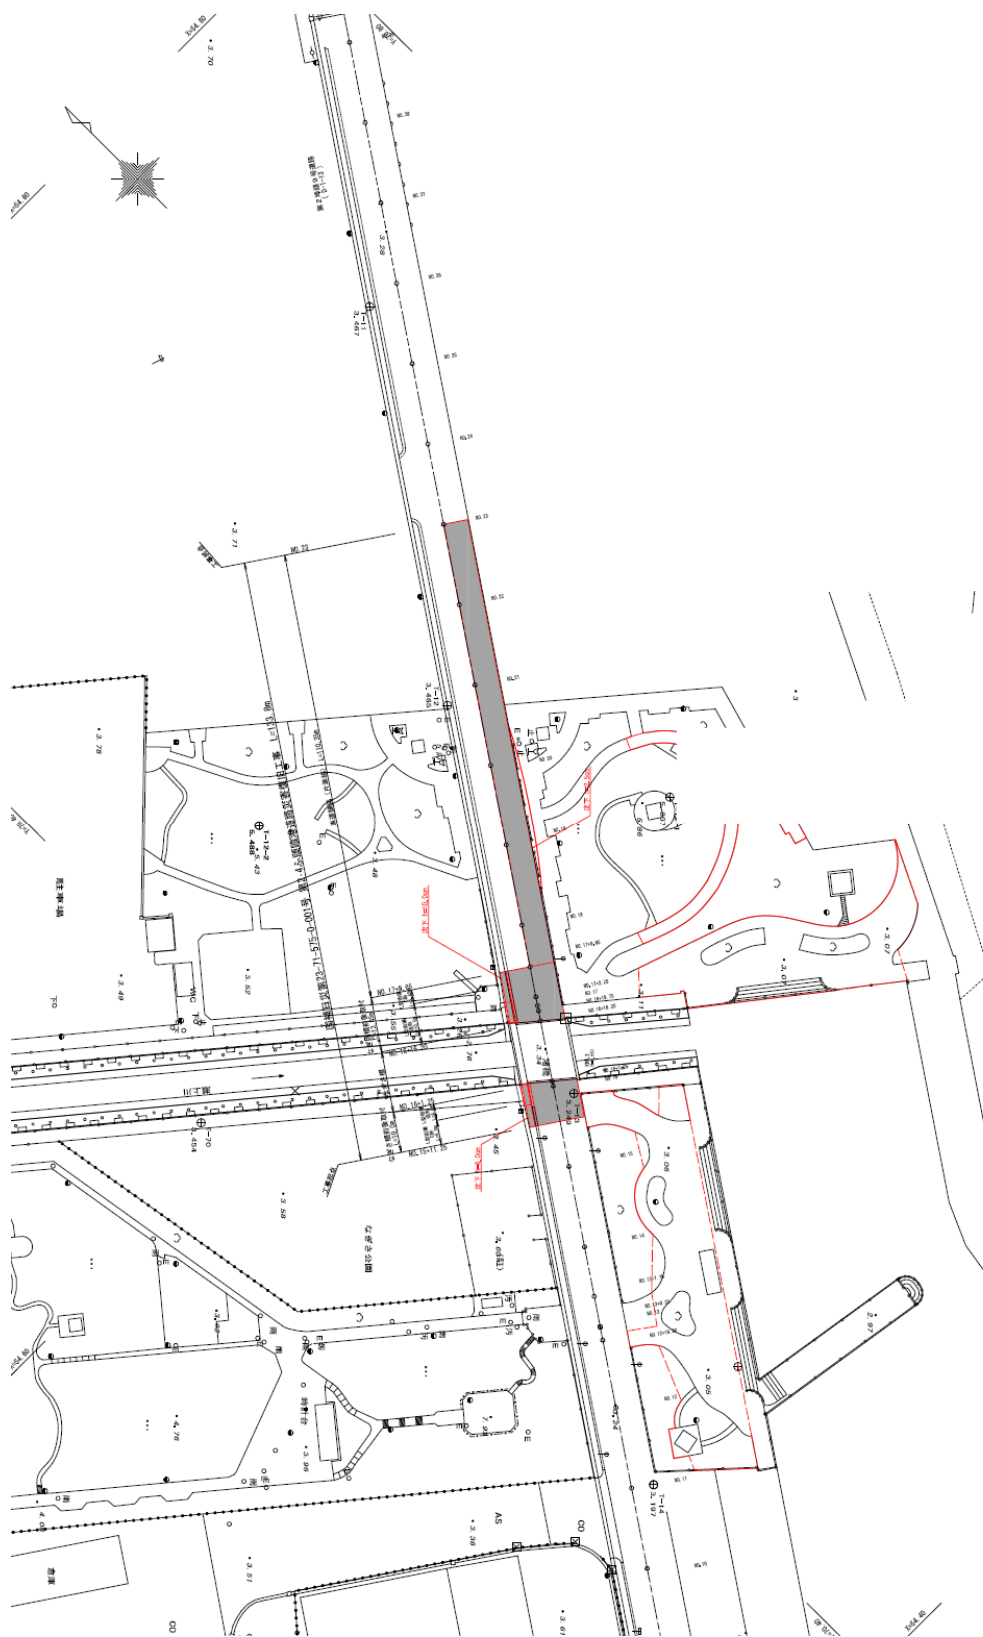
No.6 日立港区\_第2埠頭 9号道路、第4埠頭 1号道路の平面図（復旧後）
